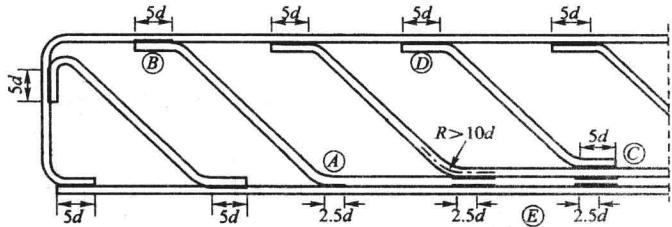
焊接钢筋骨架焊缝尺寸图
